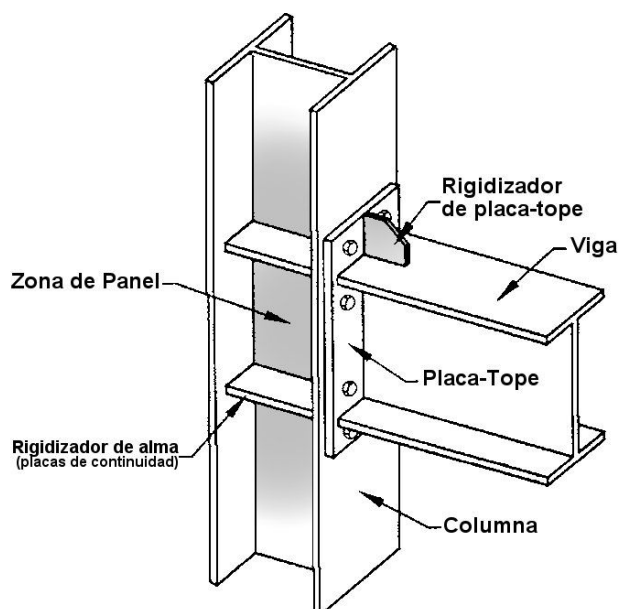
Conexión placa-tope de 8 tornillos rigidizada con placas de continuidad.
